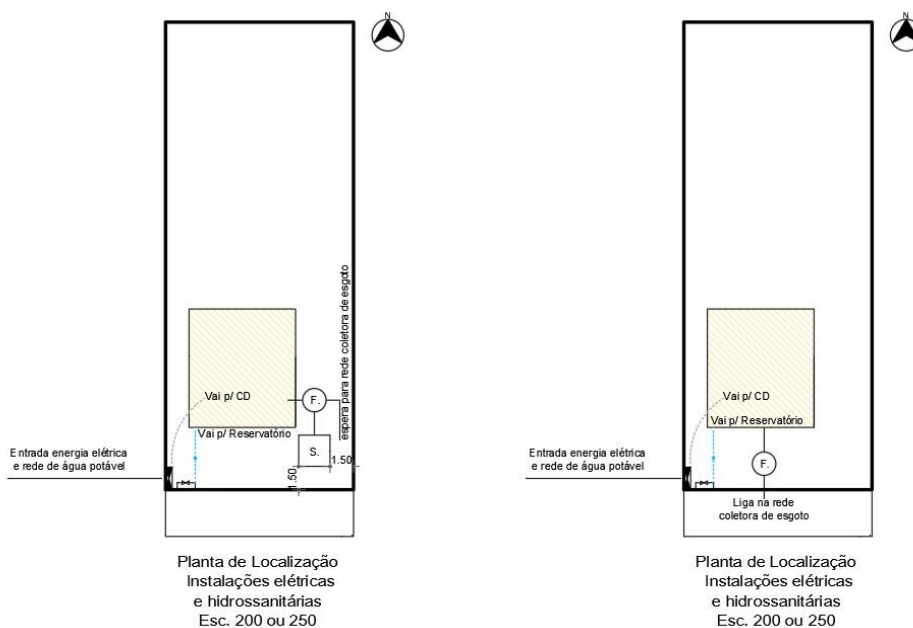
Croquis demonstrativos da planta de localização das Implantações Elétricas e Hidrossanitárias
